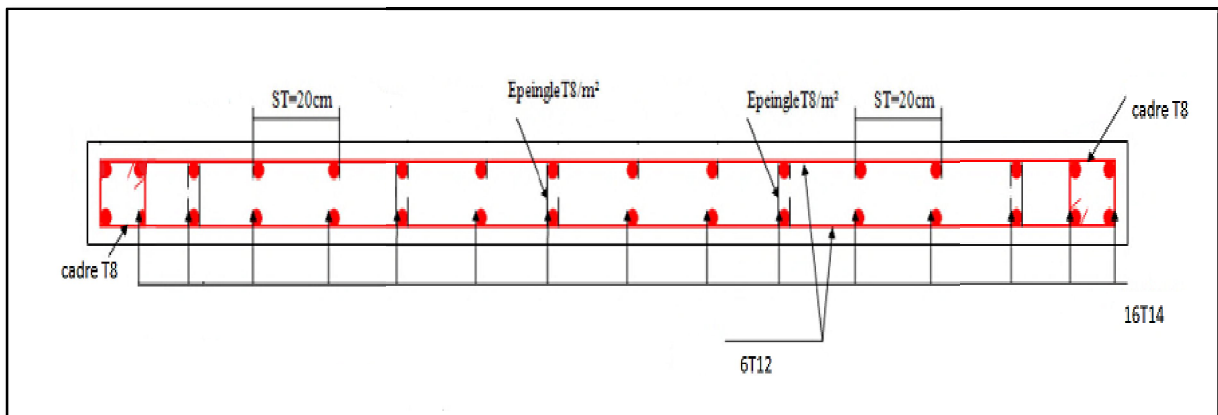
Schéma du ferrailage du voile de 160 cm (étage).
